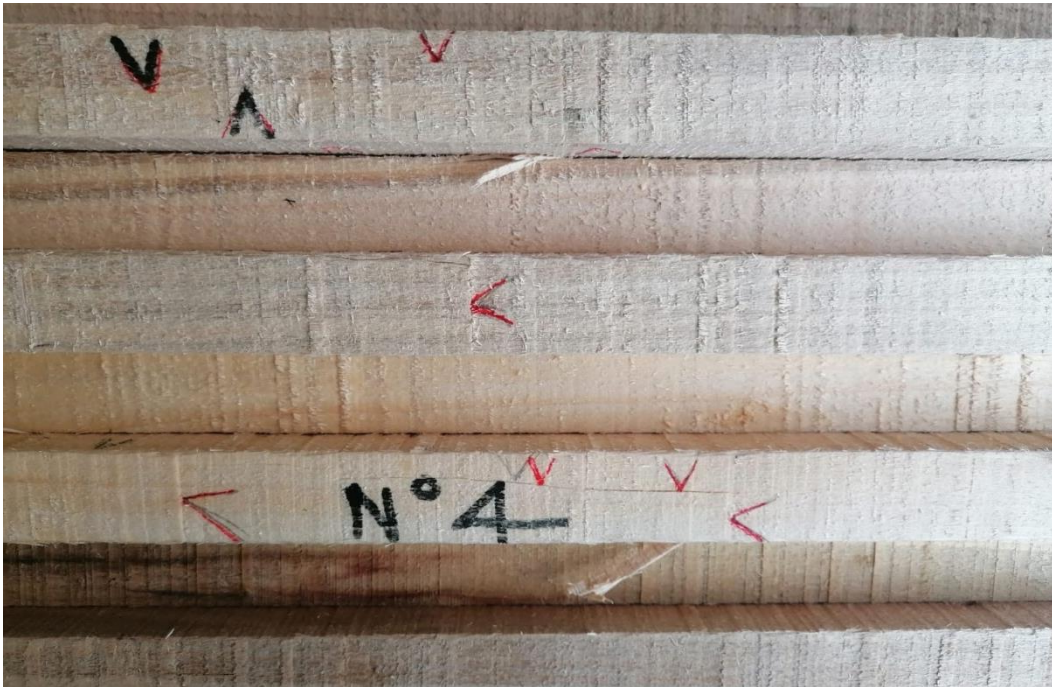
Photo des différentes fissures suite à rupture de la dalle 4
